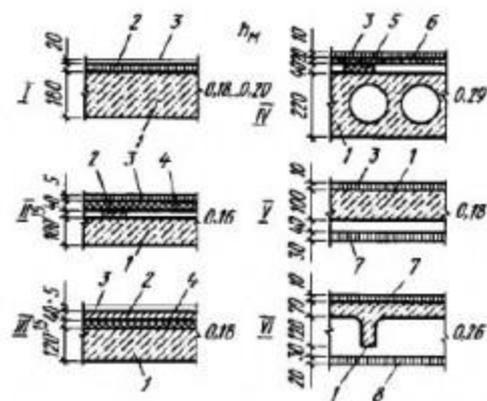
Типы панельных междуэтажных перекрытий и полов по ним:
